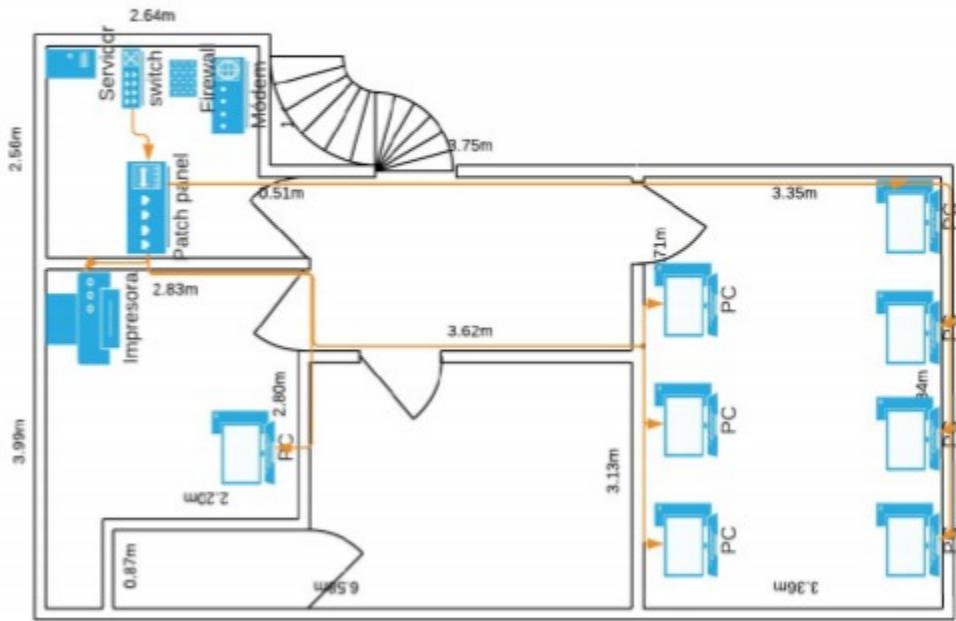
Plano Equipos Álvaro Zarate (2021)
